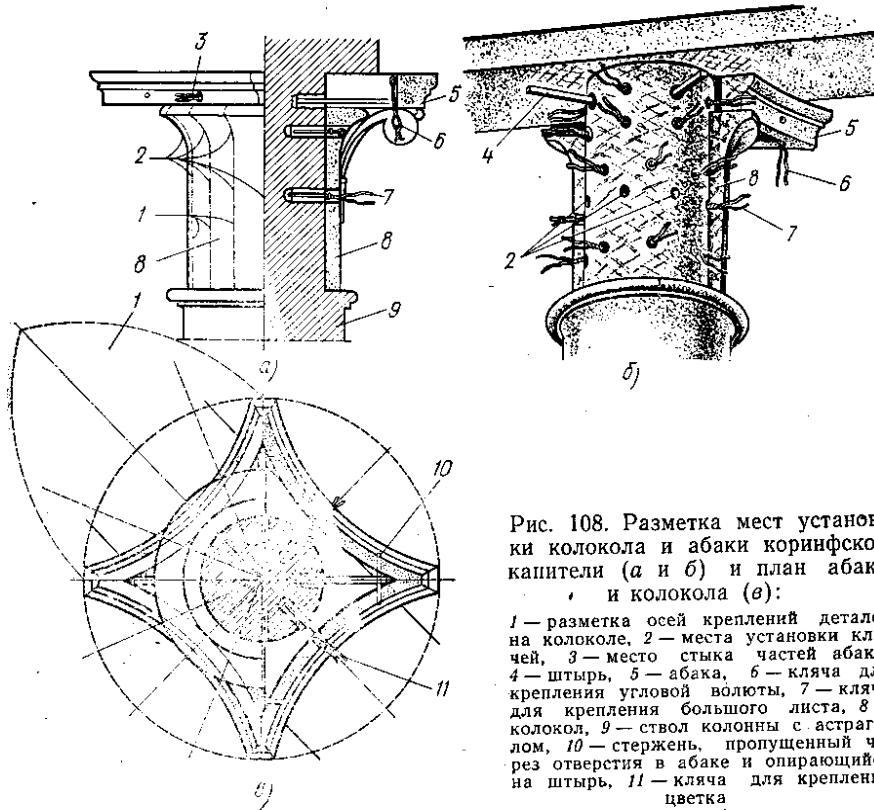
Разметка мест установки колокола и абаки коринфской капители (а и б) и план абаки и колокола (в):
